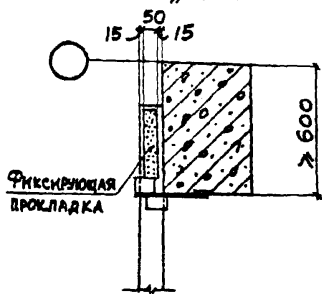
В ПОПЕРЕЧНЫХ ПЕРЕГОРОДКАХ У КРАЙНИХ КОЛОНН ЗДАНИЯ С ВЫСОТОЙ СЕЧЕНИЯ КОЛОННЫ  $\leq 500$
